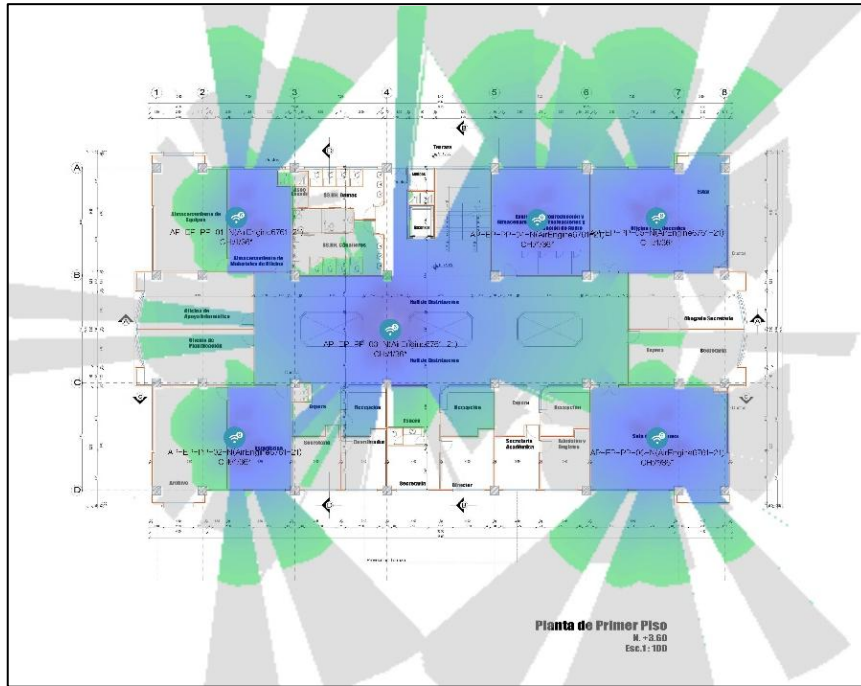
Edificio de Posgrados - Planta de Primer Piso
